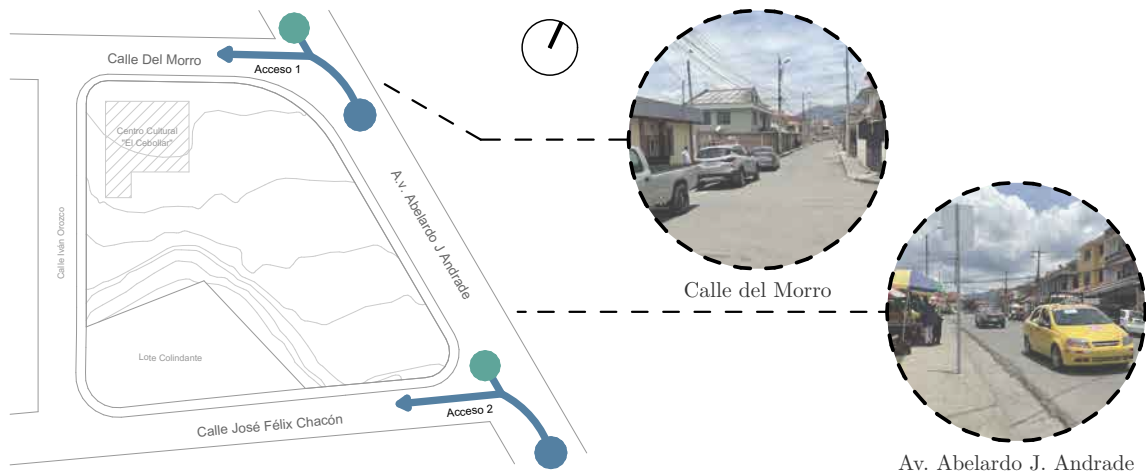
Planta Accesibilidad. Elaborado: Autores.
